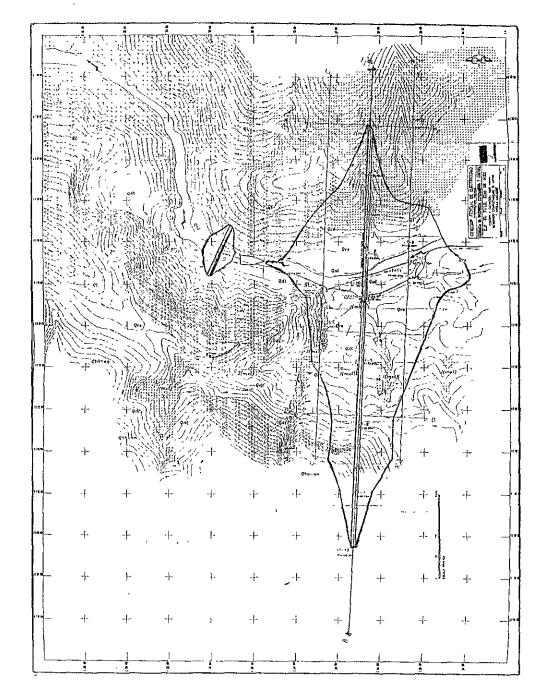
Vista en planta de la cortina de materiales graduados con elevación de corona a la cota 1605 msnm, retrando totalmente la arcilla lacustre
